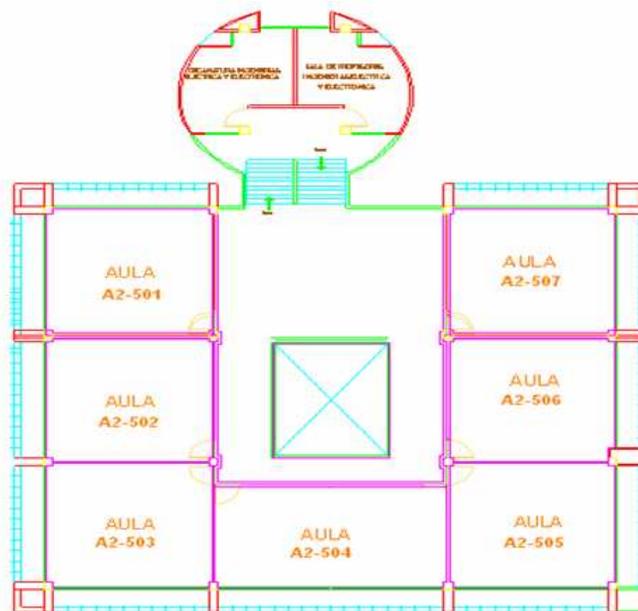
Vista en planta quinto piso Bloque de aulas 2
